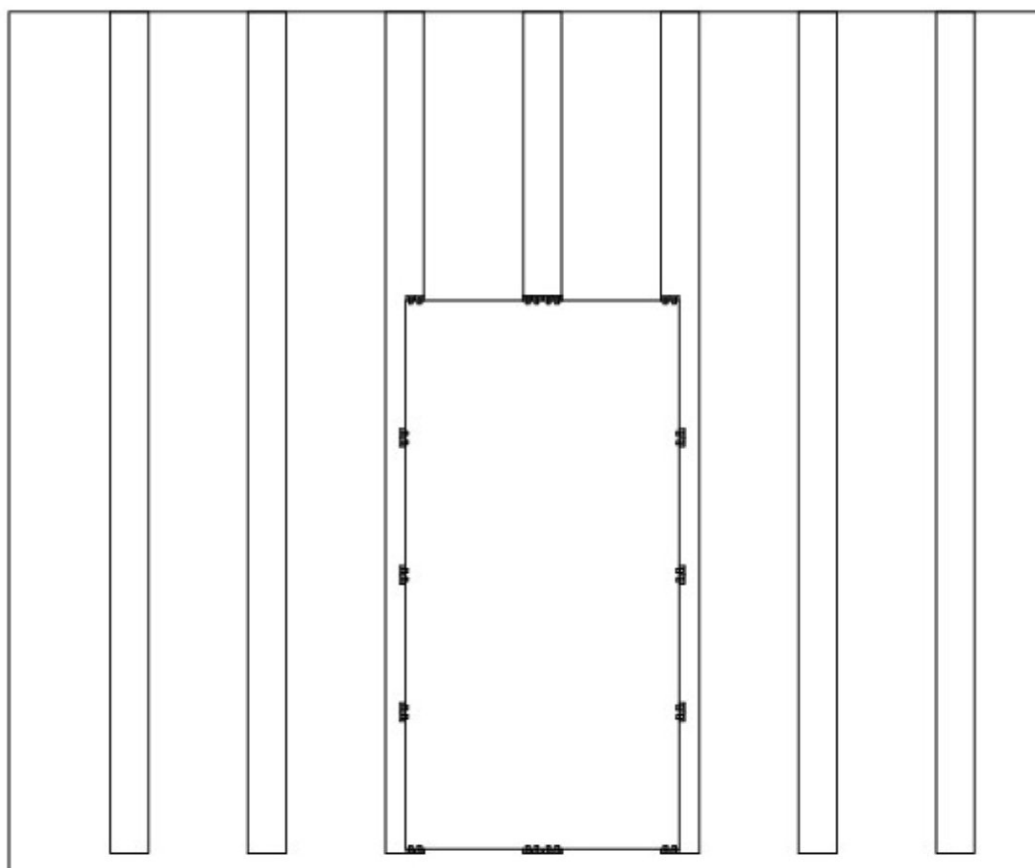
Pose des profilés d'aluminium pour les plaques disposées verticalement
